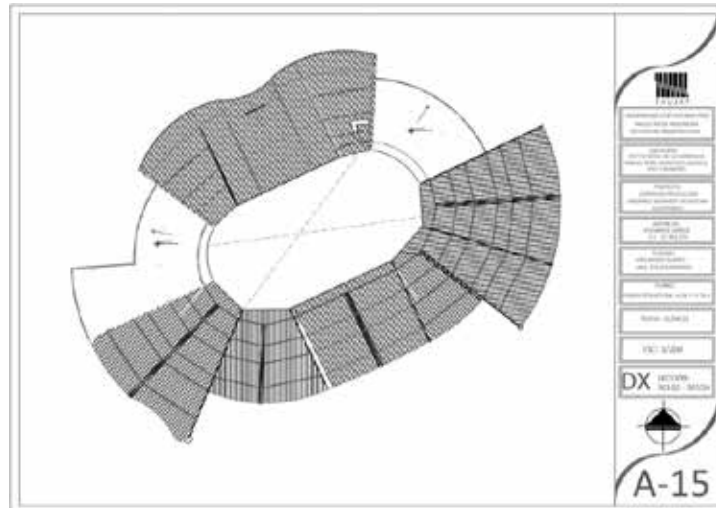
Planta Estructural + 6.00 + 5.74 m del Sistema Acuapónico.
